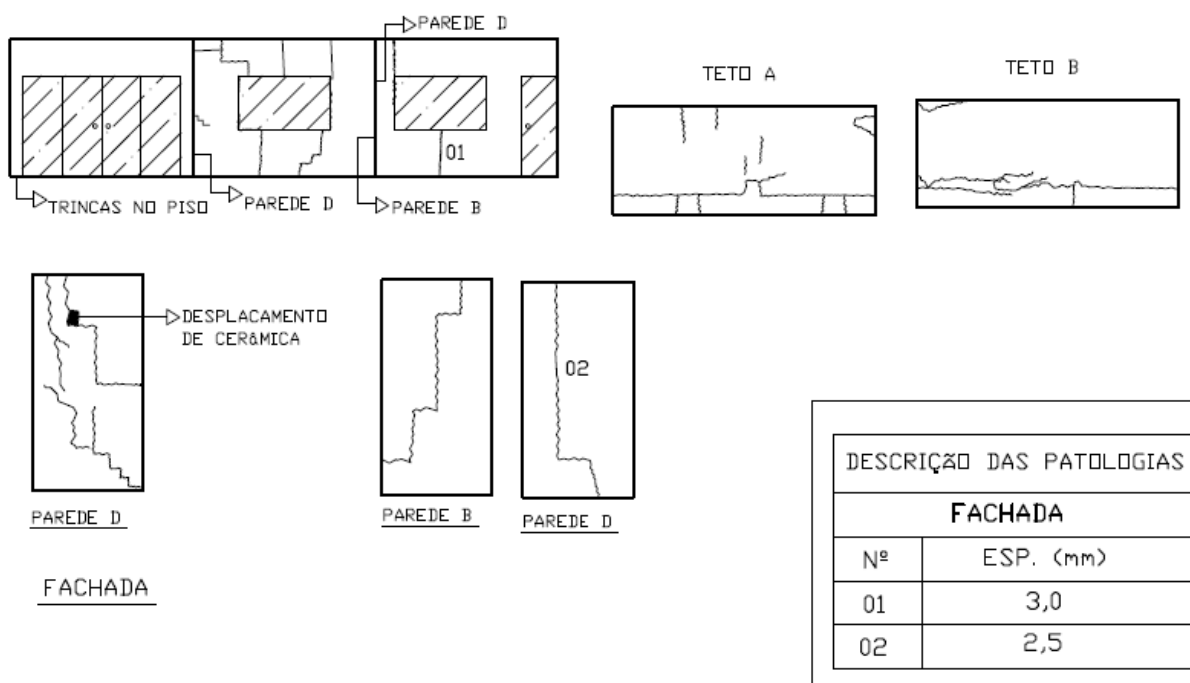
Mapeamento de trincas na Fachada da edificação.
